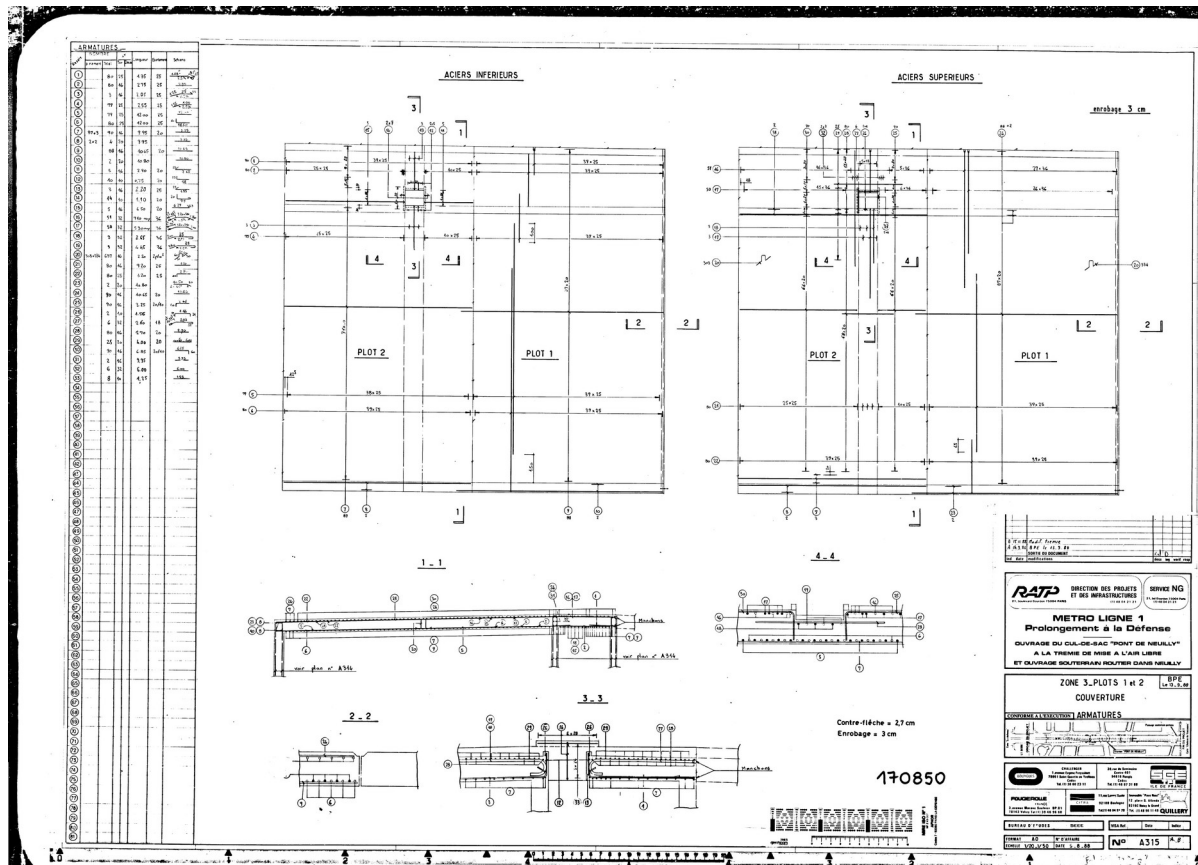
Ferrailage traverses 1 et 2, plan 170850
